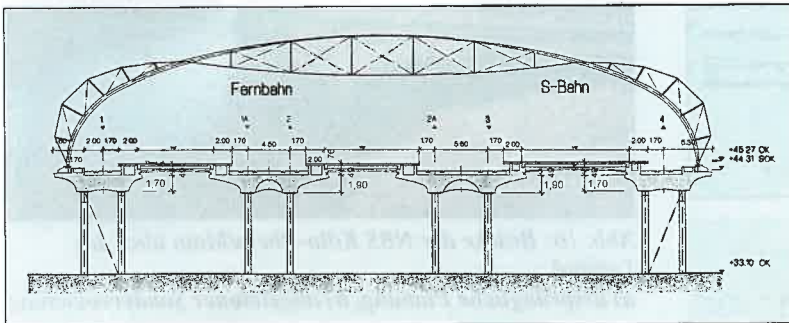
Bahnbrücken am Lehrter Bahnhof in Berlin (im Bau)
